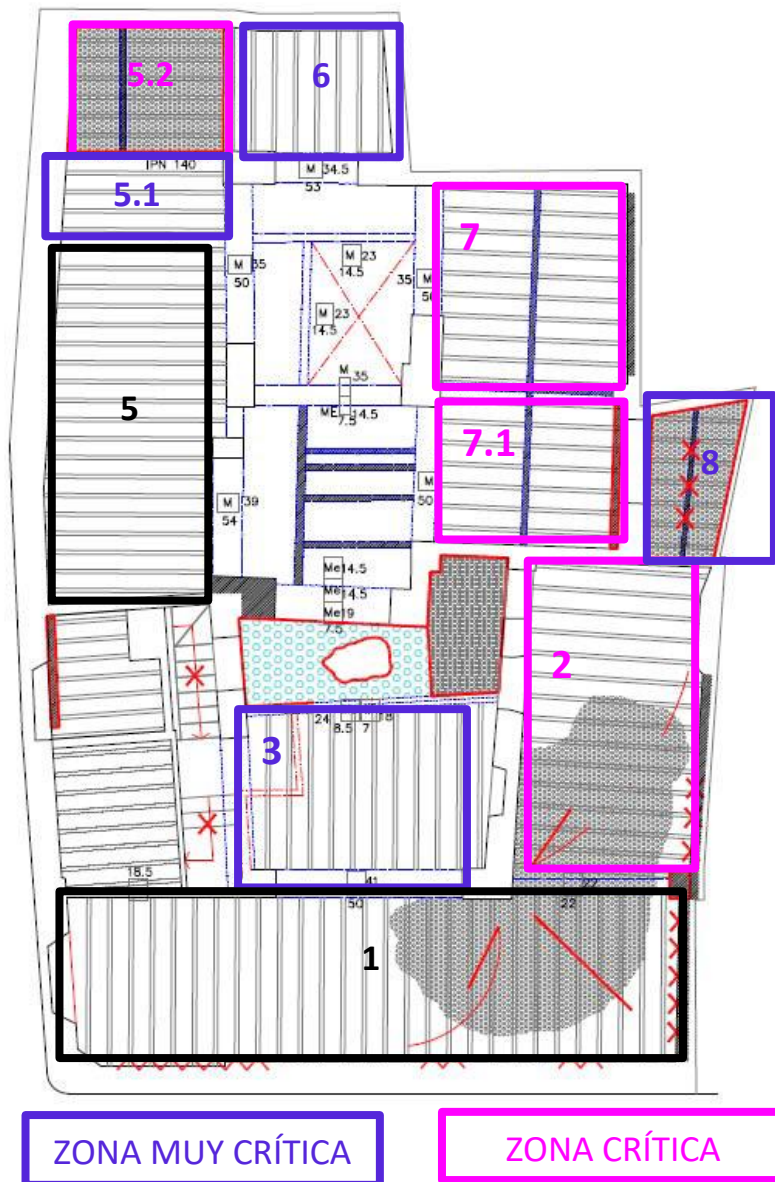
Plano de forjado de planta 1ª indicando zonas inspeccionadas.
